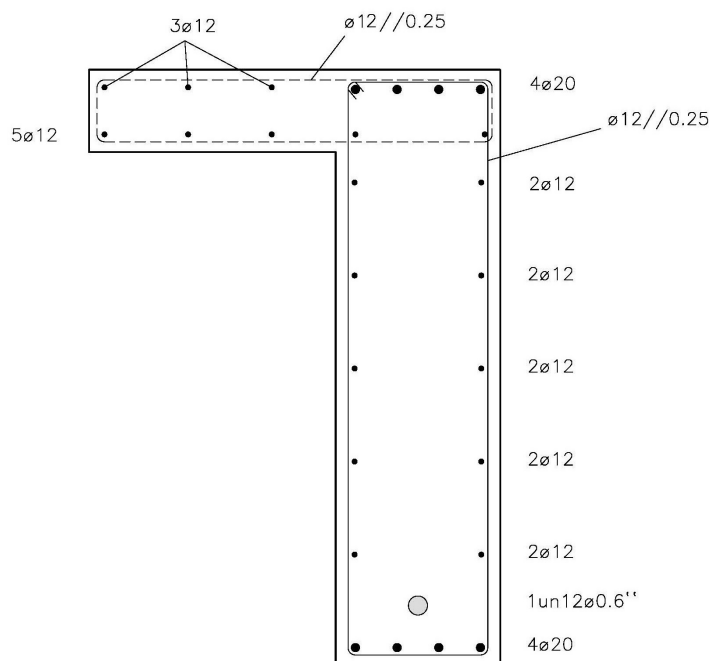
Corte Transversal a Meio Vão da Viga de Bancada Pré-Esforçada
